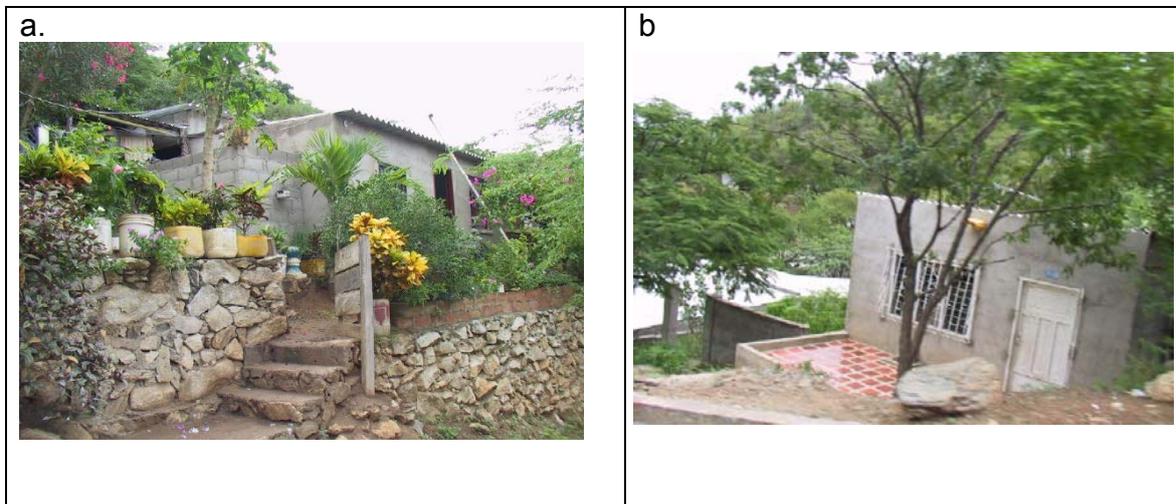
Calidad de las Viviendas por materiales de construcción en Cerro La Llorona. a.) Vivienda construida en madera y mampostería. b.) Vivienda ubicada en alta pendiente construida en mampostería en obra negra.
